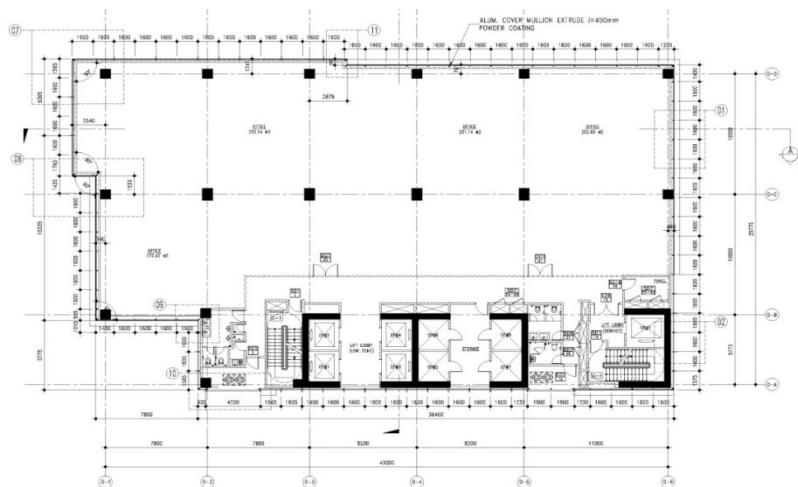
Facade curtain wall* unitized sistem. Sumber : *Facade Principals of construction
